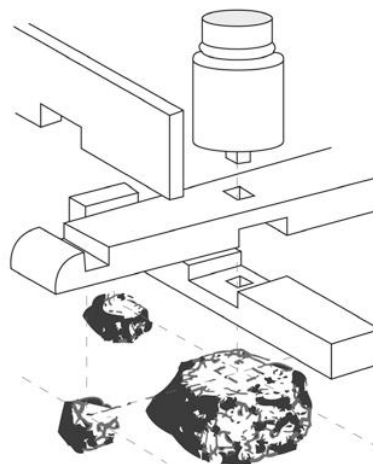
Detalle estructura iglesias de Noruega stavverk
